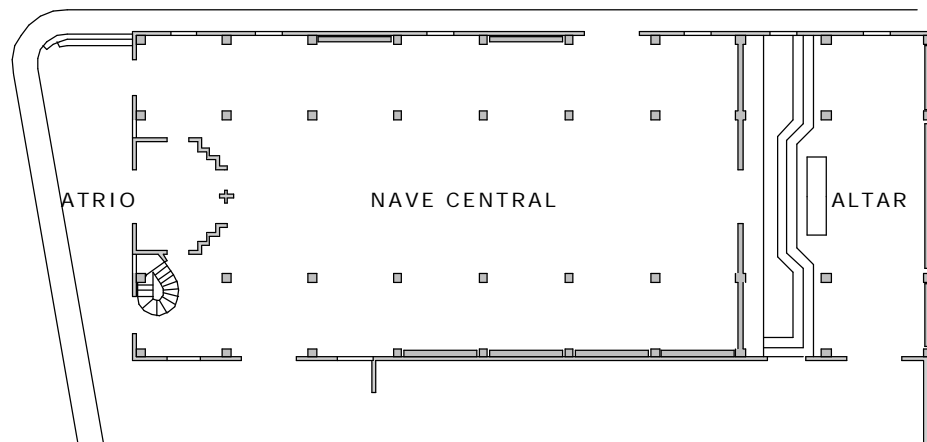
Planta tipológica, Templo de Los Agustinos. Calle 18
